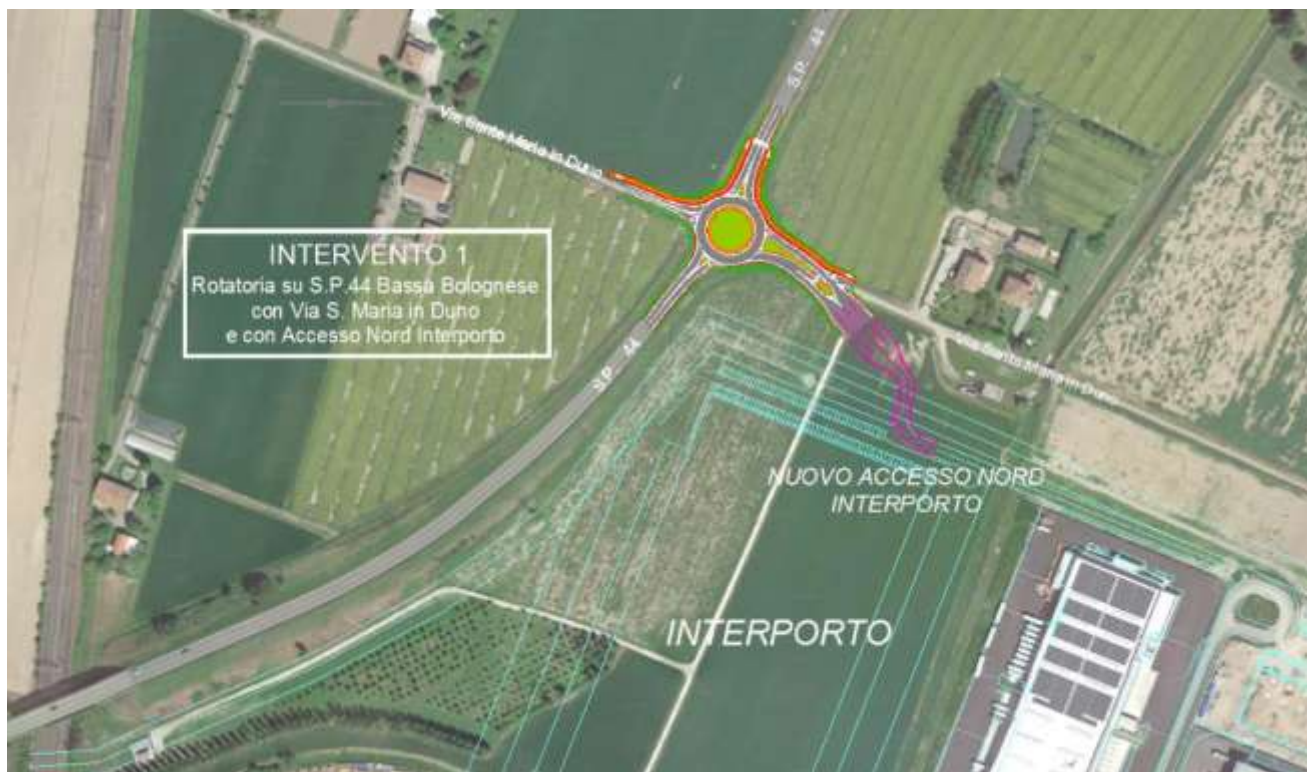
Planimetria di progetto intersezione SP44 – Via S. Maria Induno
